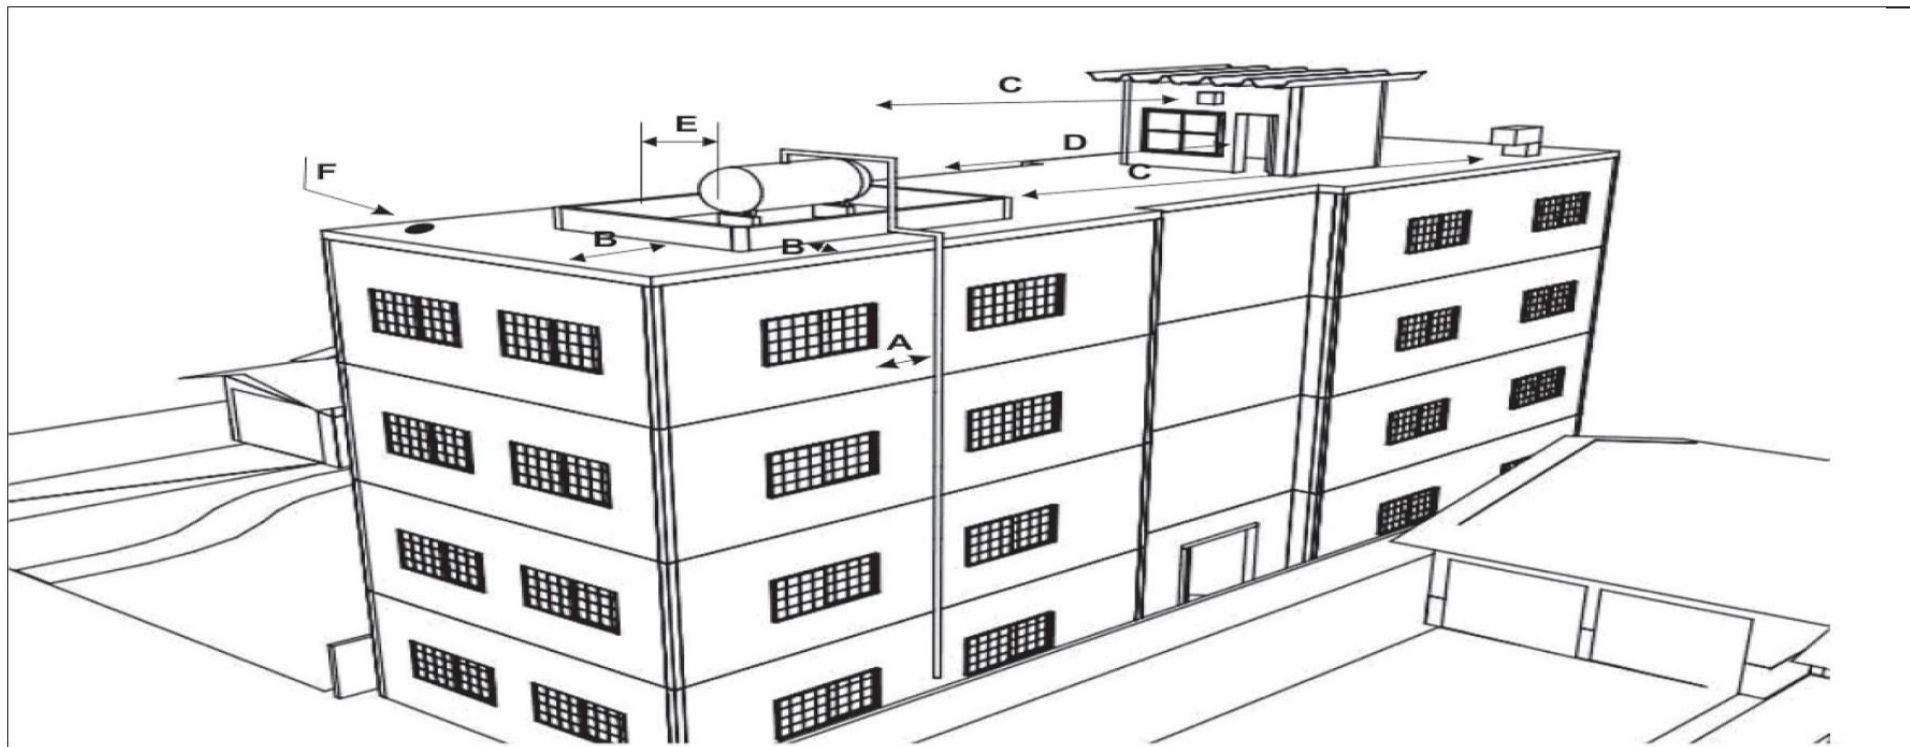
C – Instalação de recipientes em teto e lajes de cobertura de edificações (informativo).
